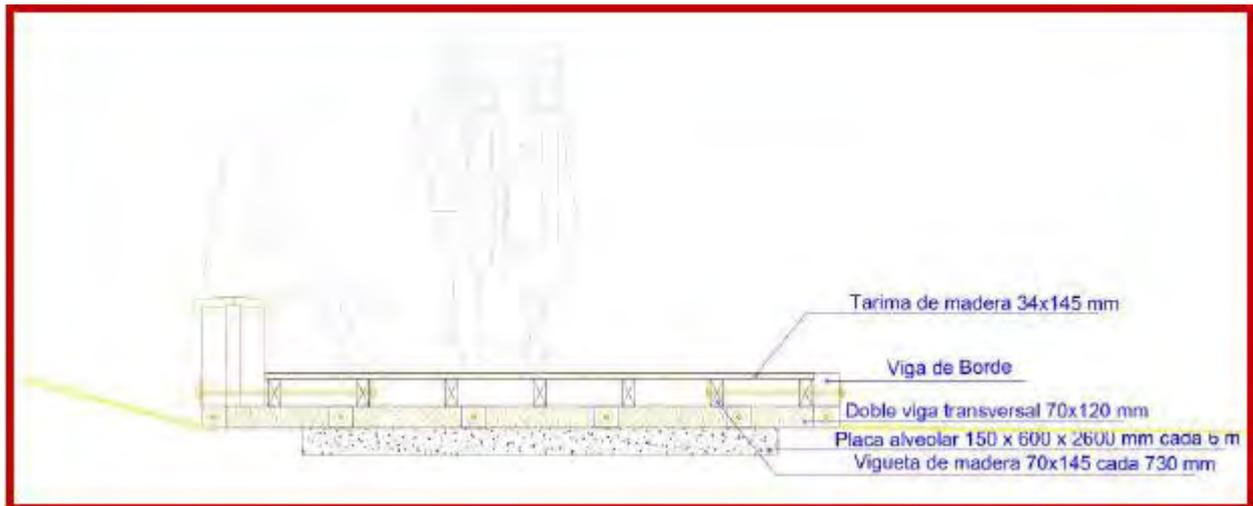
Sección tipo de diseño propuesta en sendero en la playa (Fuente: Proyecto básico 2018)
